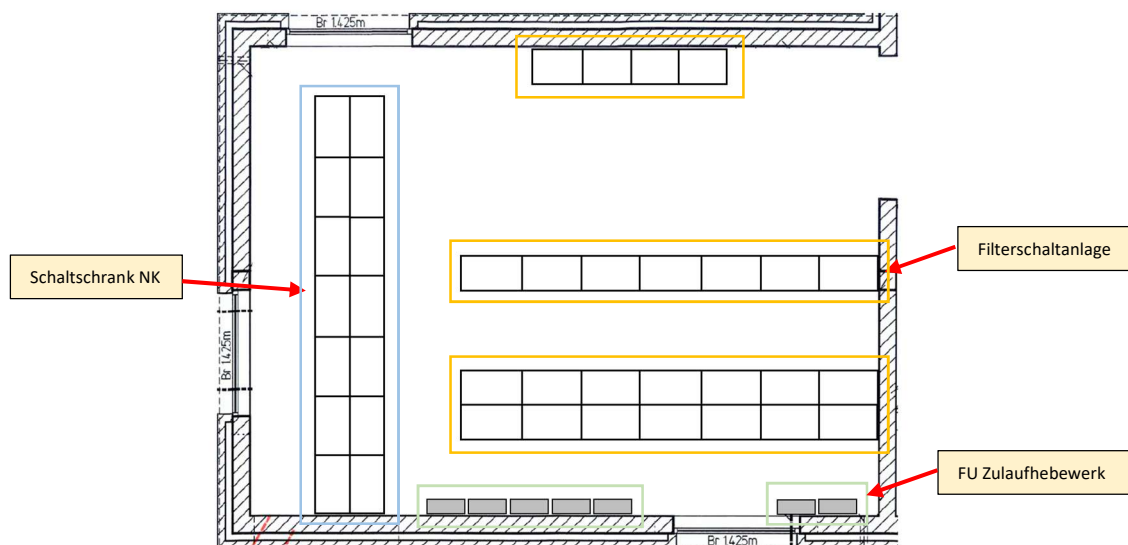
Grundriss Nachklärung und Filtration
